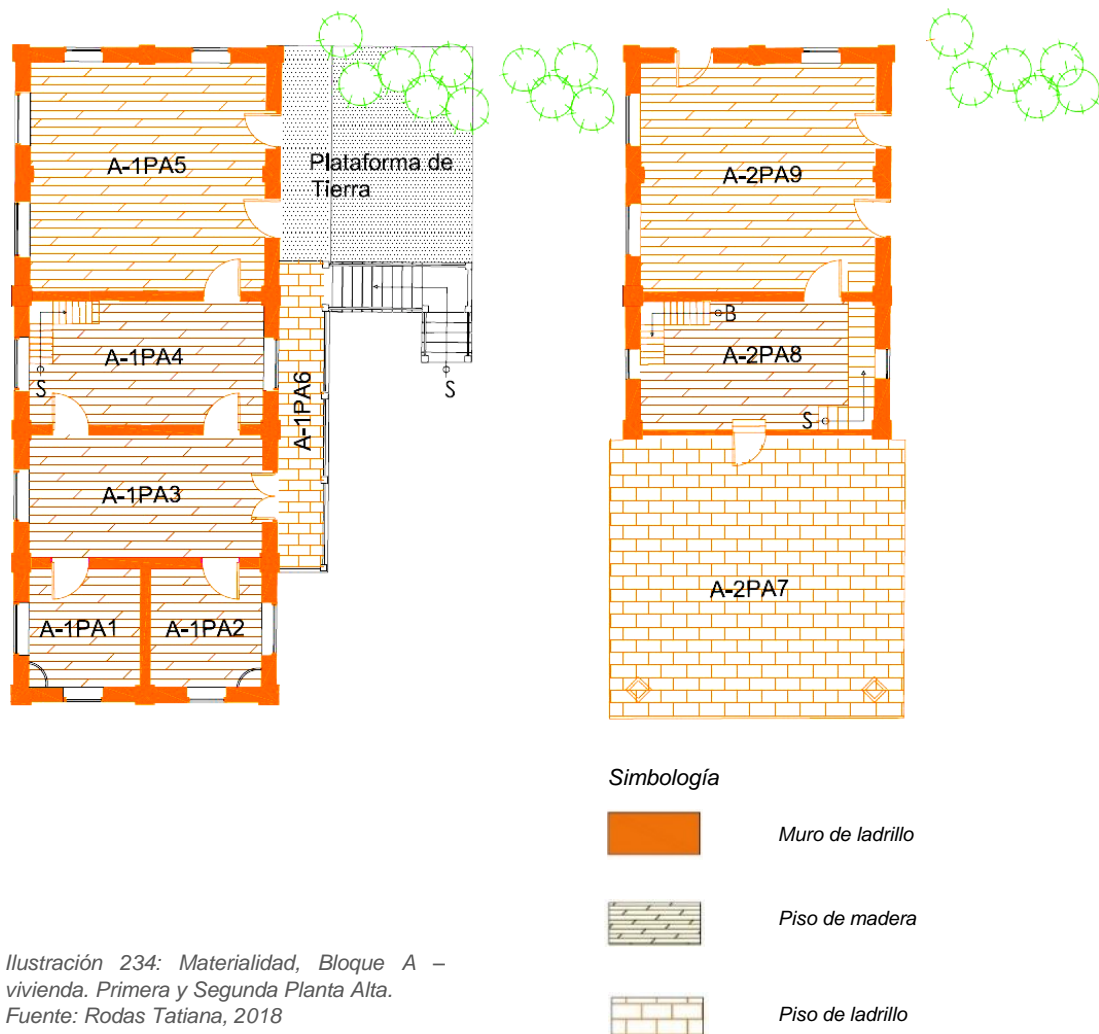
Materialidad, Bloque A – vivienda. Primera y Segunda Planta Alta.
